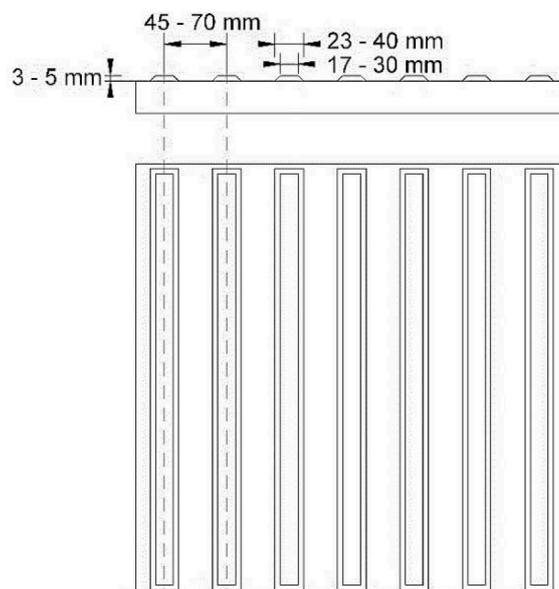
3. Gráfico con las dimensiones del pavimento de estrías
